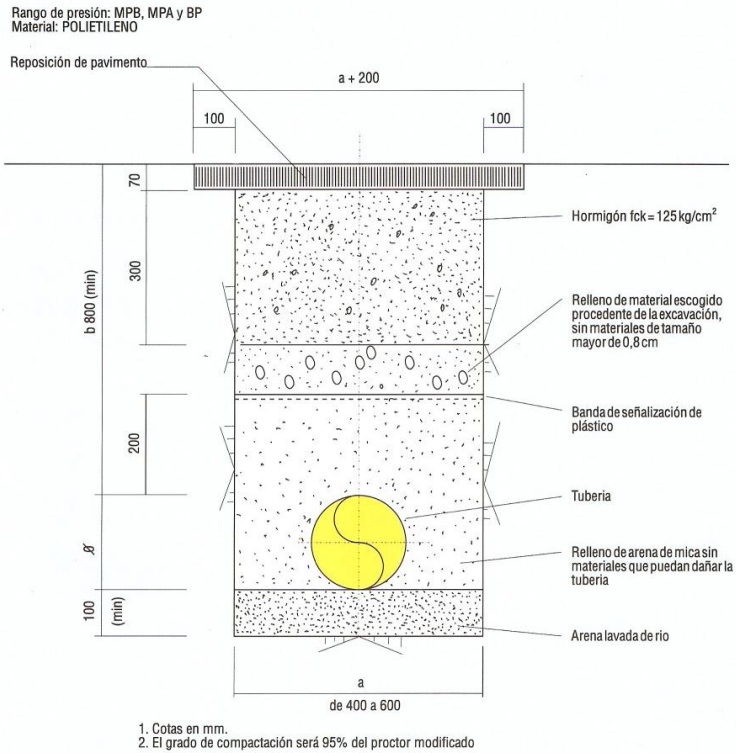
b Zanjas tipo. Zona urbana bajo calzada
